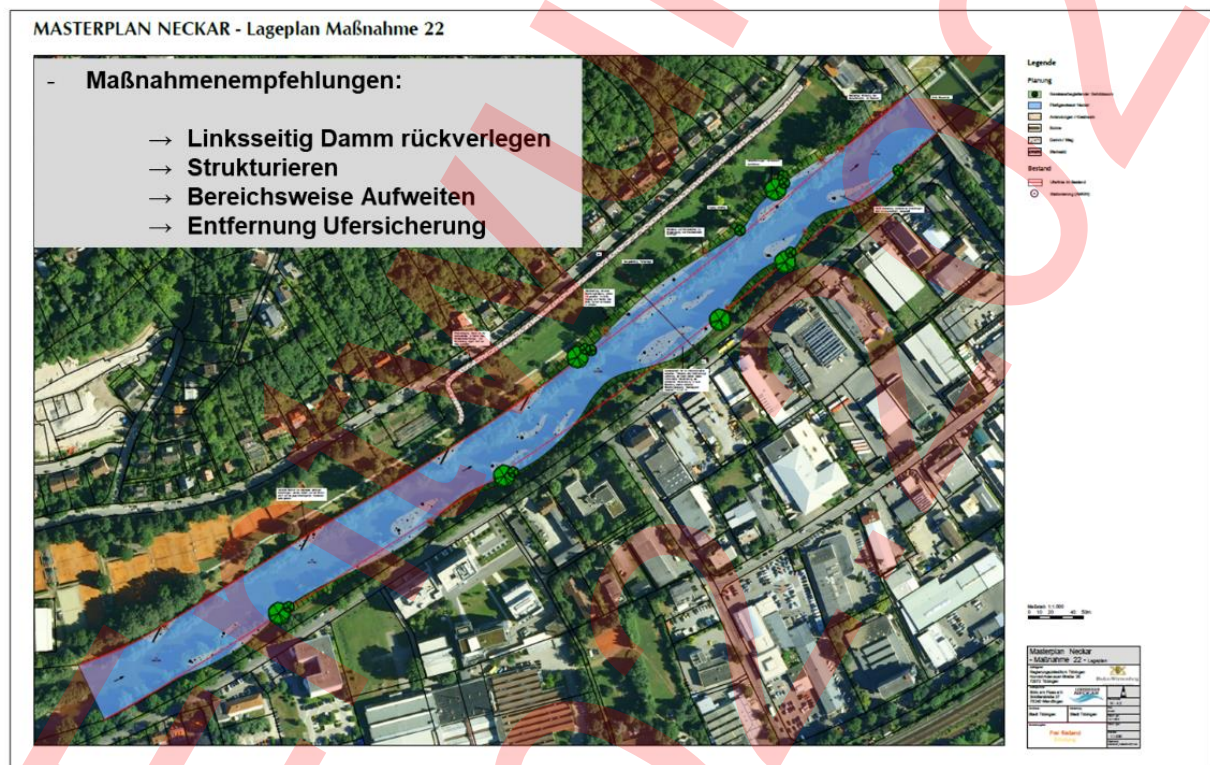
Masterplan Neckar (2014) – Lageplan Maßnahme 22
